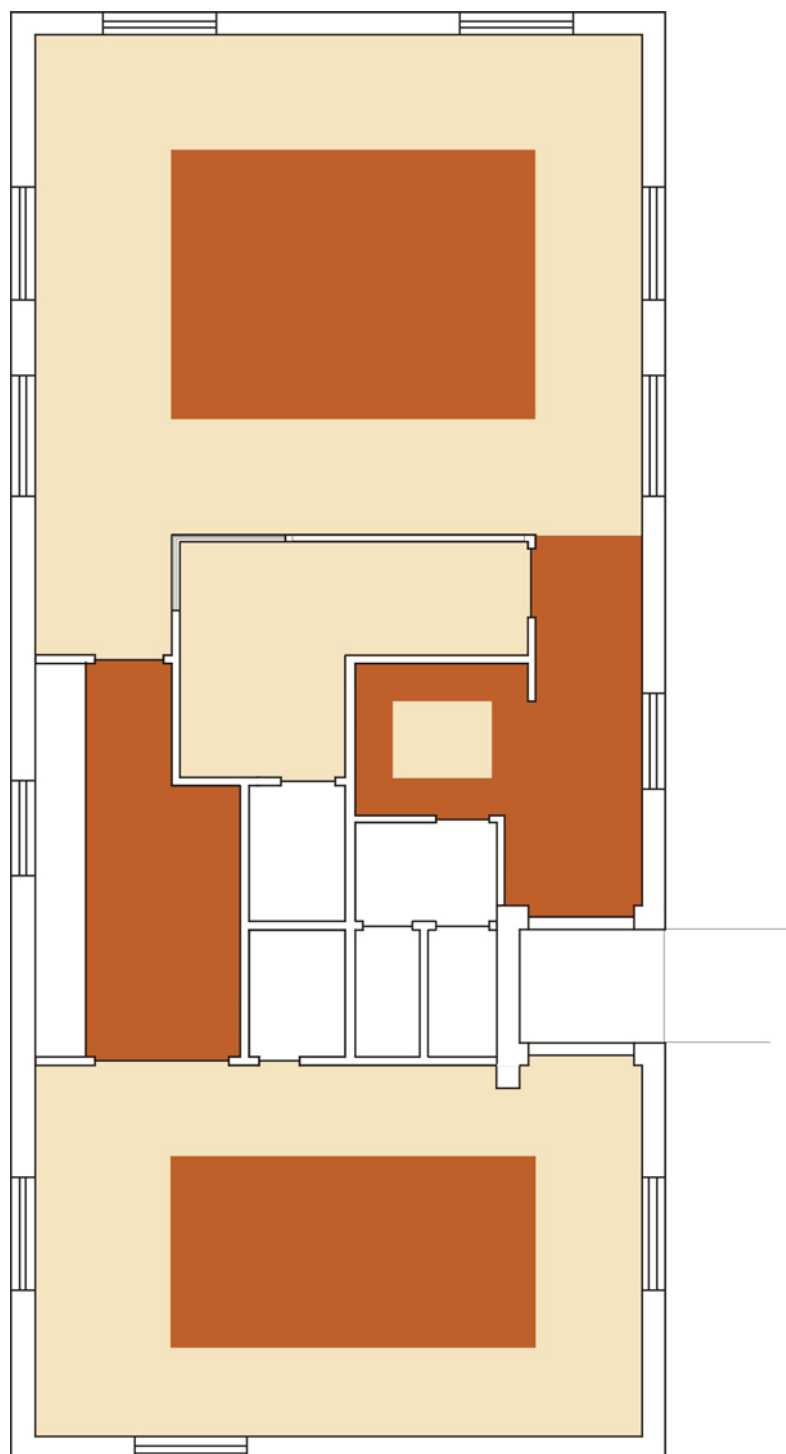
Estudo de propostas para aplicação de linóleo no pavimento
